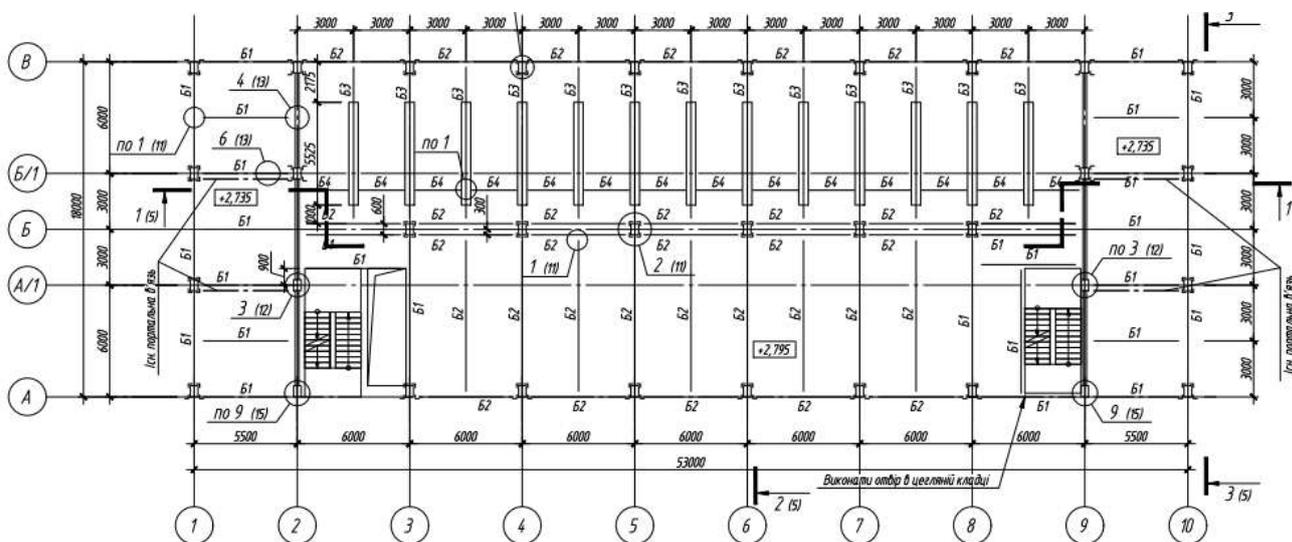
Схема розташування несучих сталевих балок нового вбудованого перекриття
